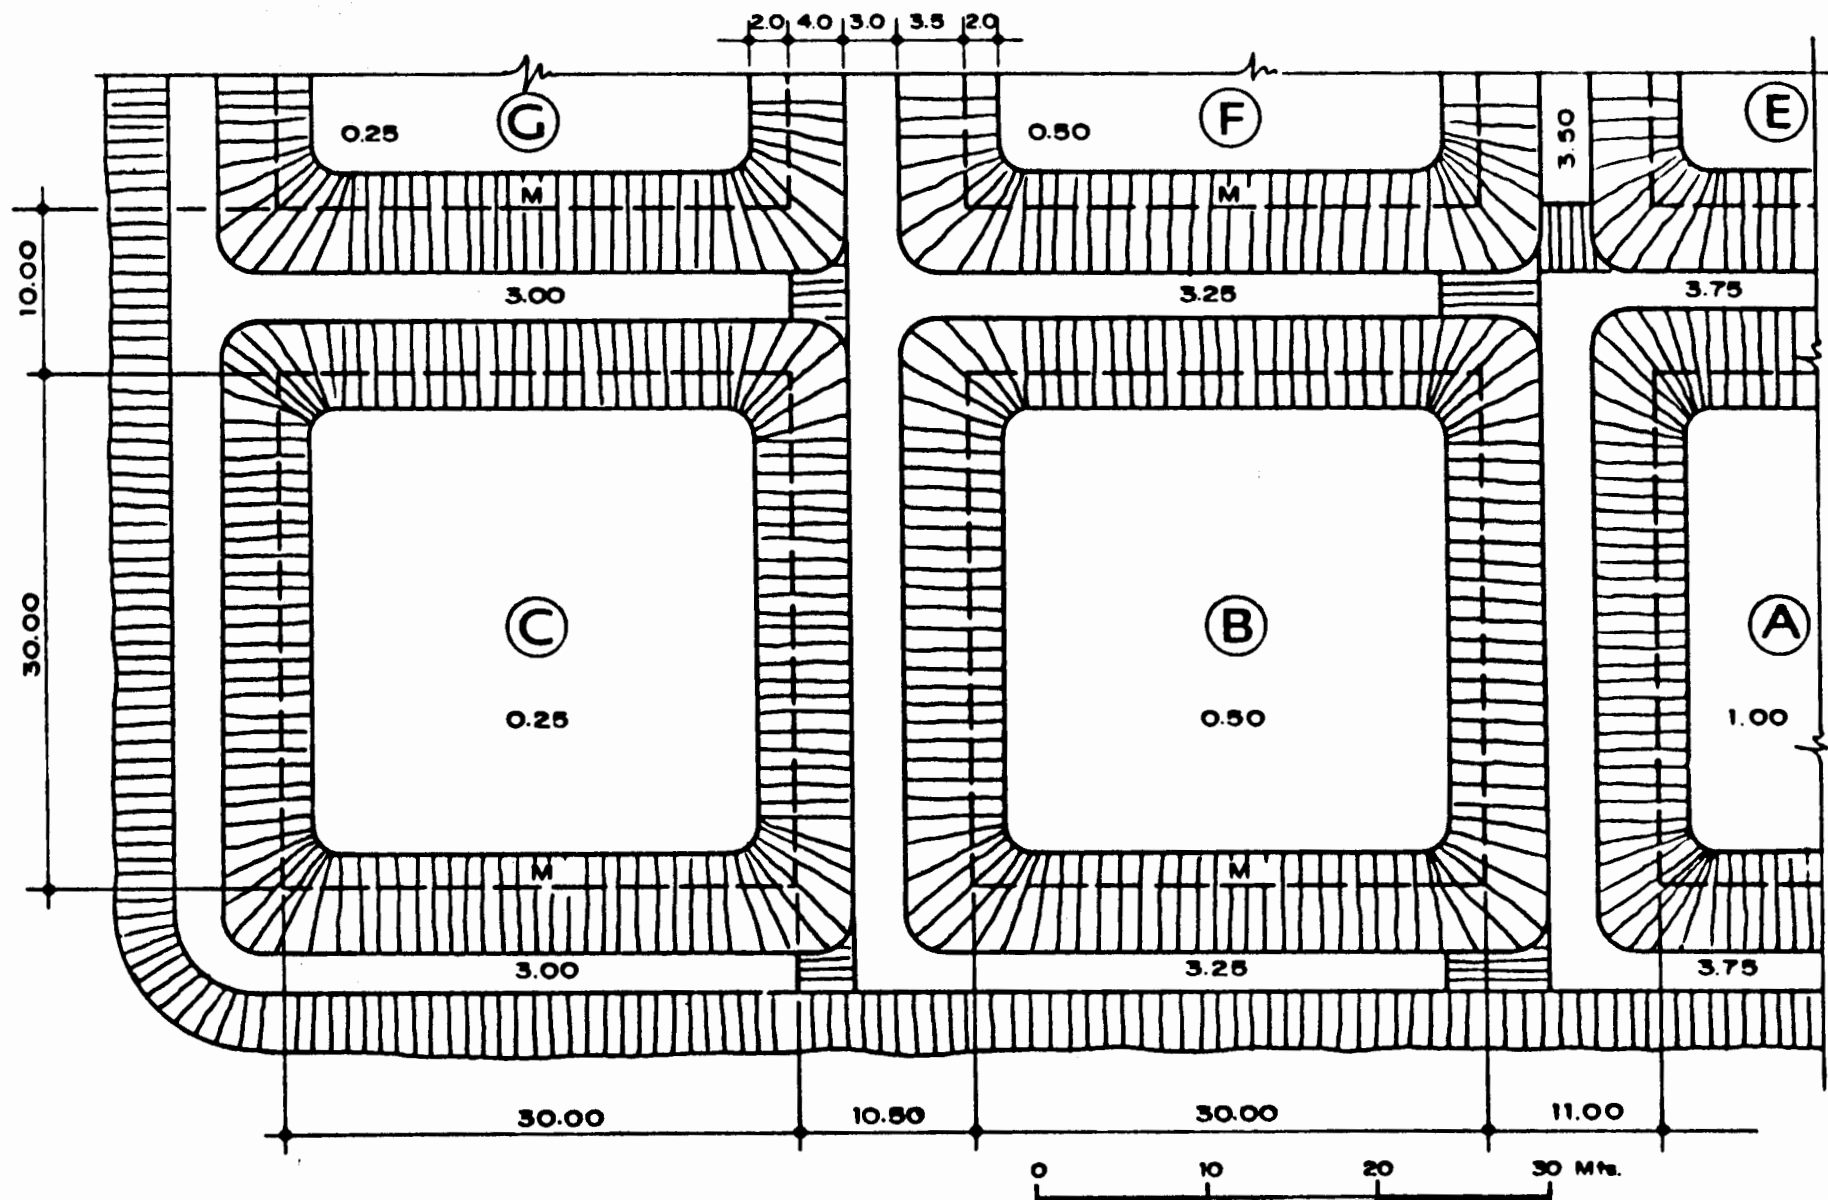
VISTA DE PLANTA DE LOS DIQUES Y DE LAS LAGUNAS C Y B
